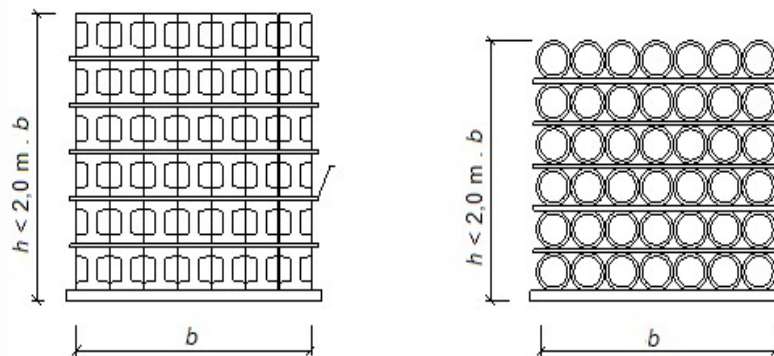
Dispositivos e pilha retangular para poste circular
